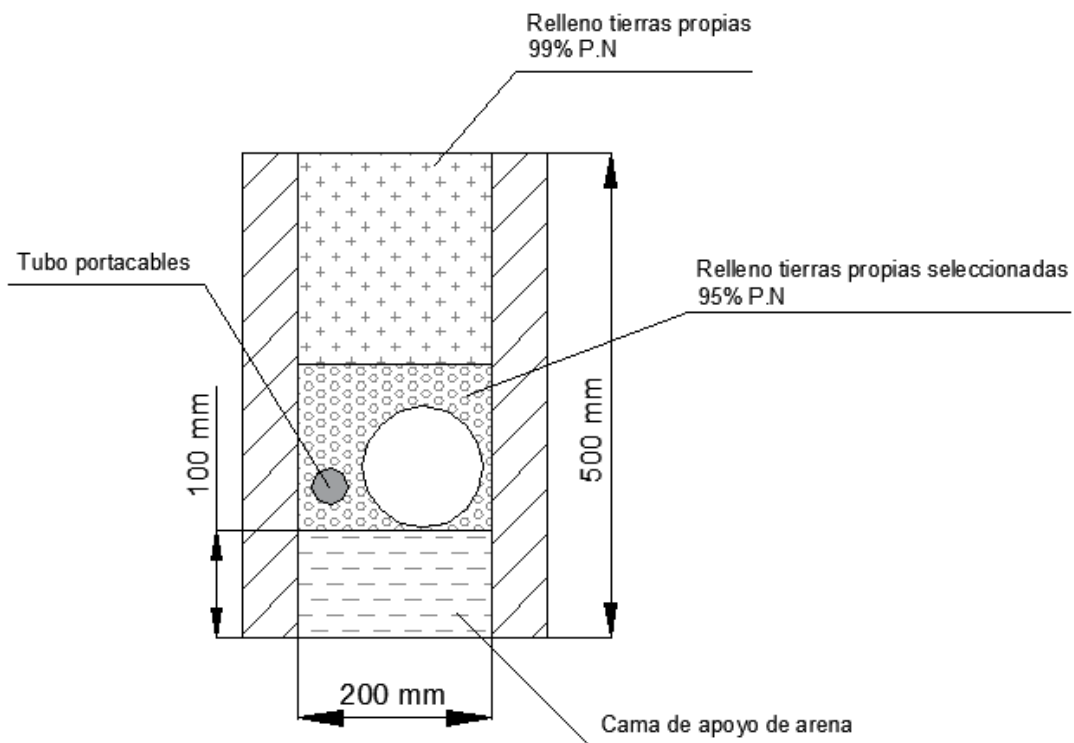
Dimensiones zanja para una única tubería y el tubo porta cables
